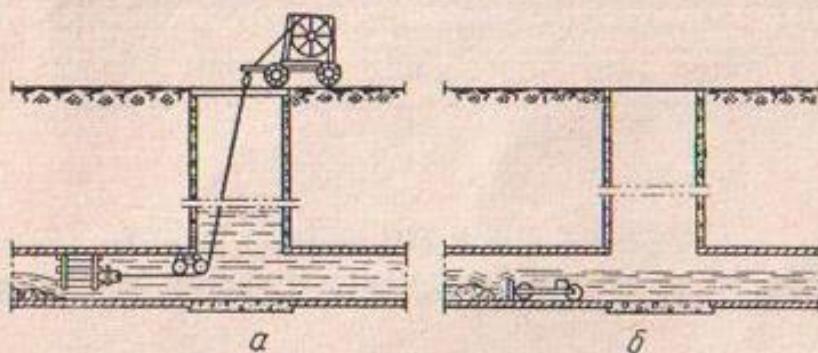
Очистка труб большого диаметра самоходным щитом:
